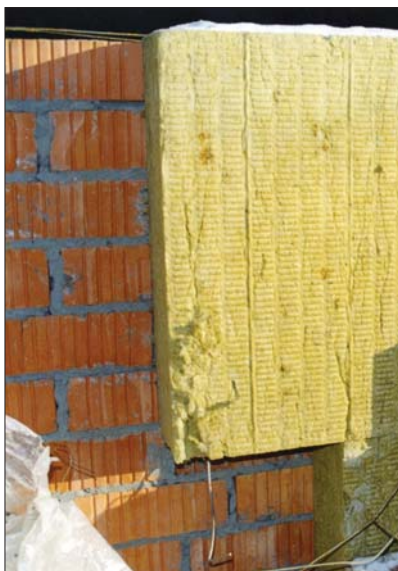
а, б, в Строительство здания англо-американской школы с наружными стенами из кладки с гибкими связями, Москва, 1999 г:
